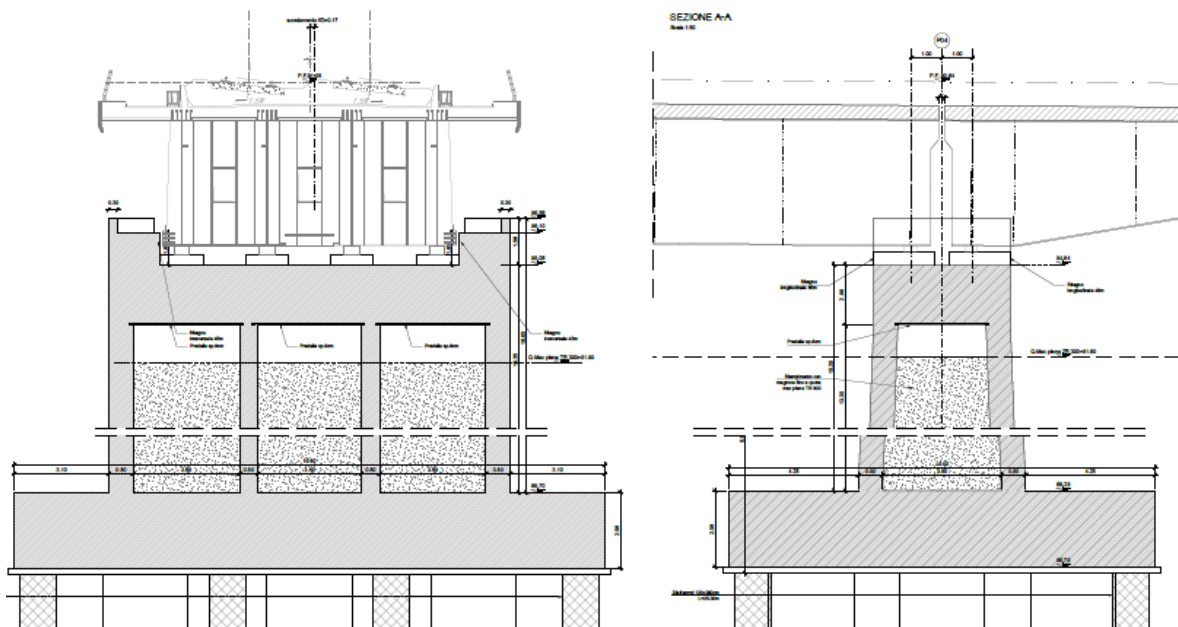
Sezione in direzione trasversale e longitudinale rispetto all'asse del viadotto pila P4
